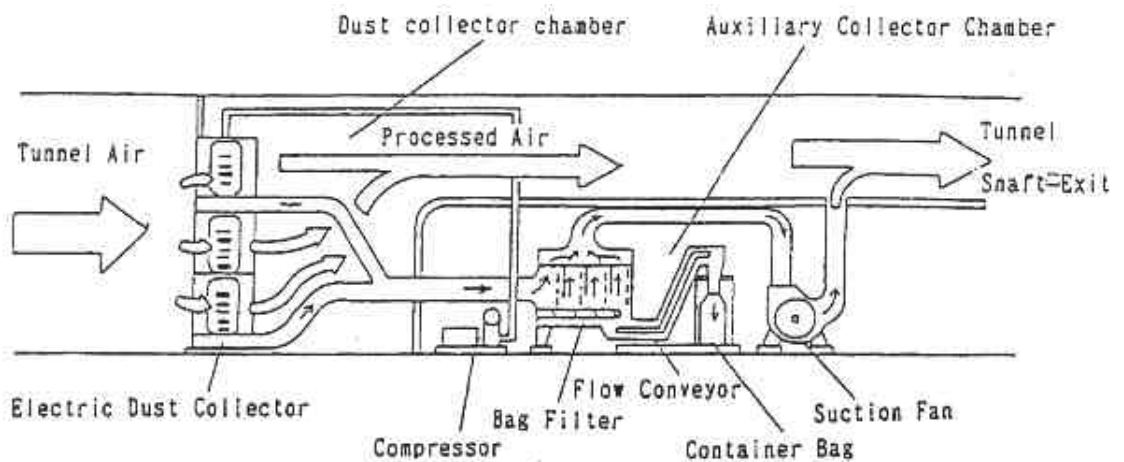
Vue générale et schéma d'une installation de filtration en tunnel
